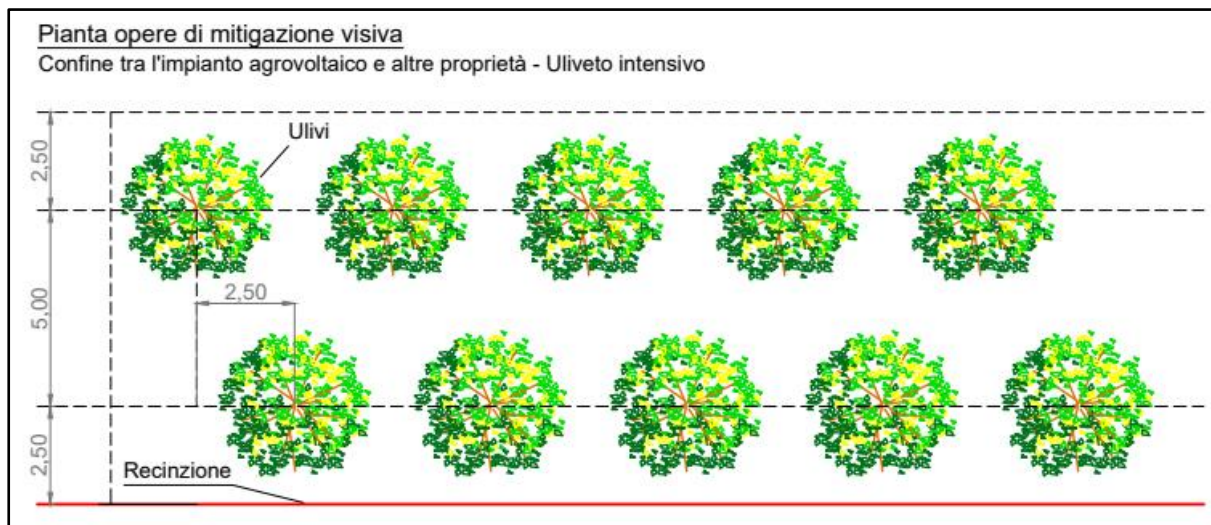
Fascia di mitigazione e schema del sesto di impianto
